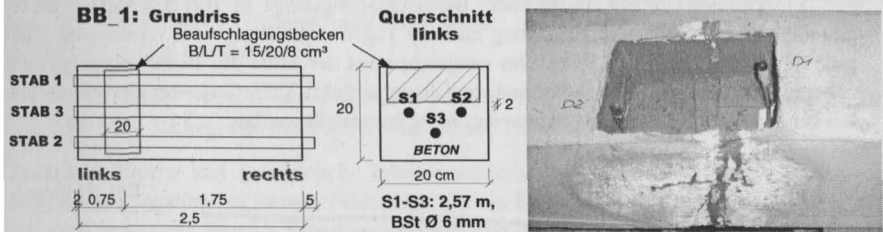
Betonbalken *BB_1*: Nachträglich durchtrennter, 2,5 m langer Betonbalken mit Grundriss und Querschnitt sowie Photo vom Beaufschlagungsbecken 19 Tage nach Beginn der NaCl-Beaufschlagung; im Beaufschlagungsbecken wurden zwei DK-Sensoren angeordnet; die Salzausblühungen sind deutlich erkennbar
